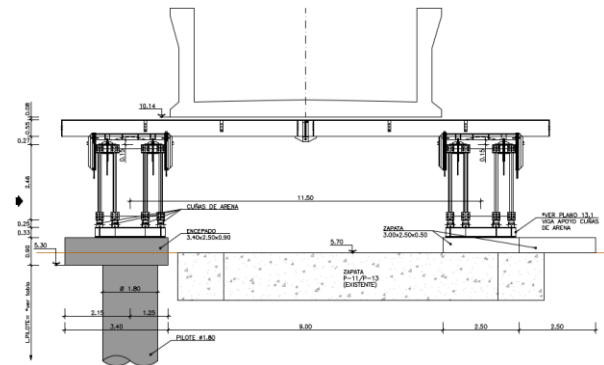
Sección transversal de apoyo de cimbra en pilas existentes (P11 y P13)
